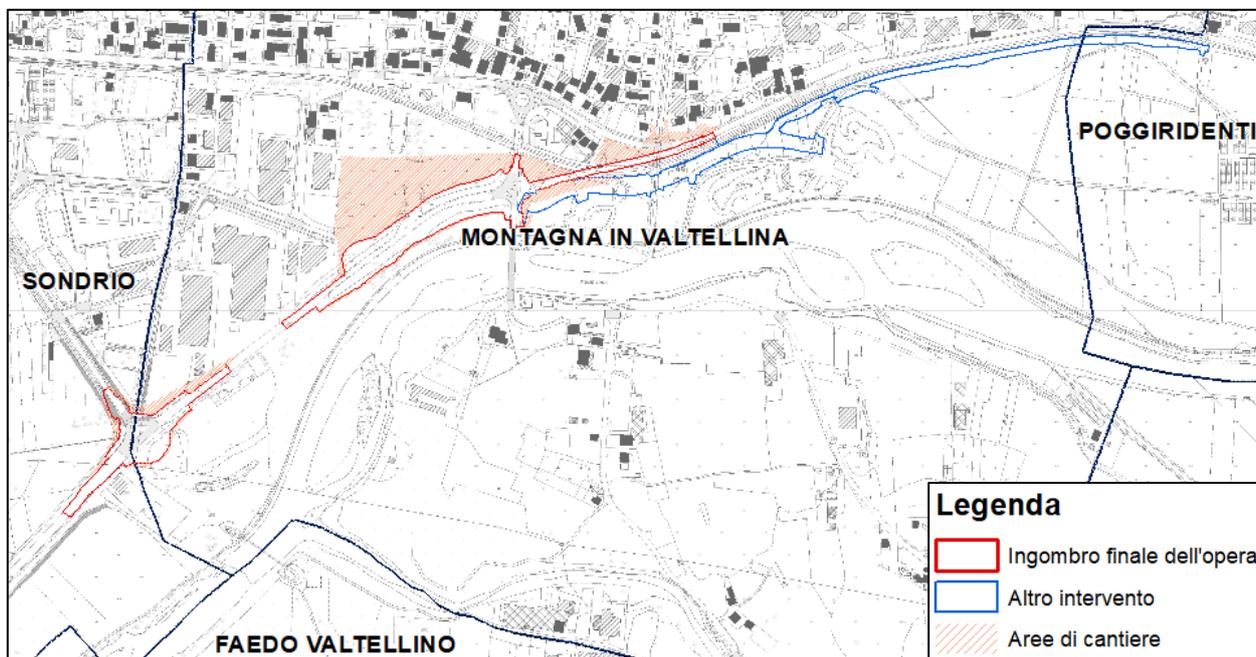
estratto planimetrico dell'ingombro degli interventi previsti ed assetto finale dell'area.
